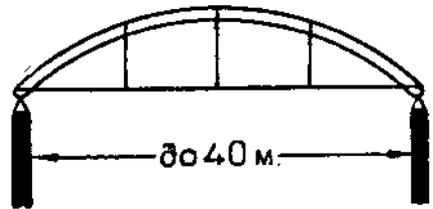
схема трехшарнирной арки по системе Хетцера со сплошной стенкой.
